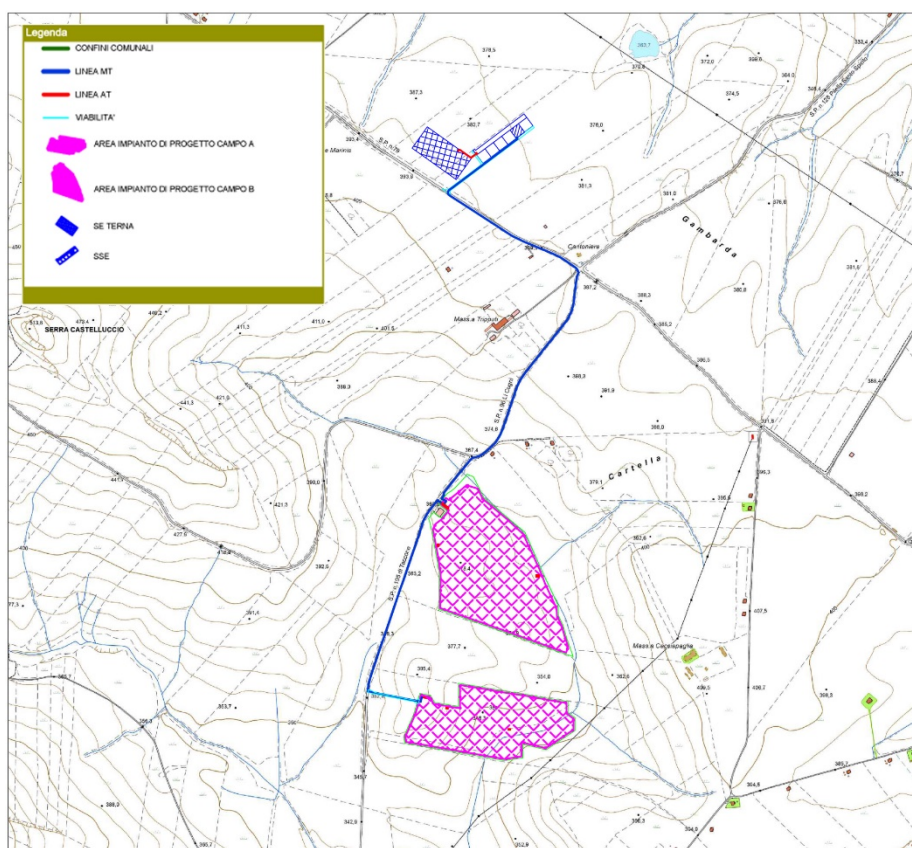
Planimetria generale dell'impianto fotovoltaico su CTR.
